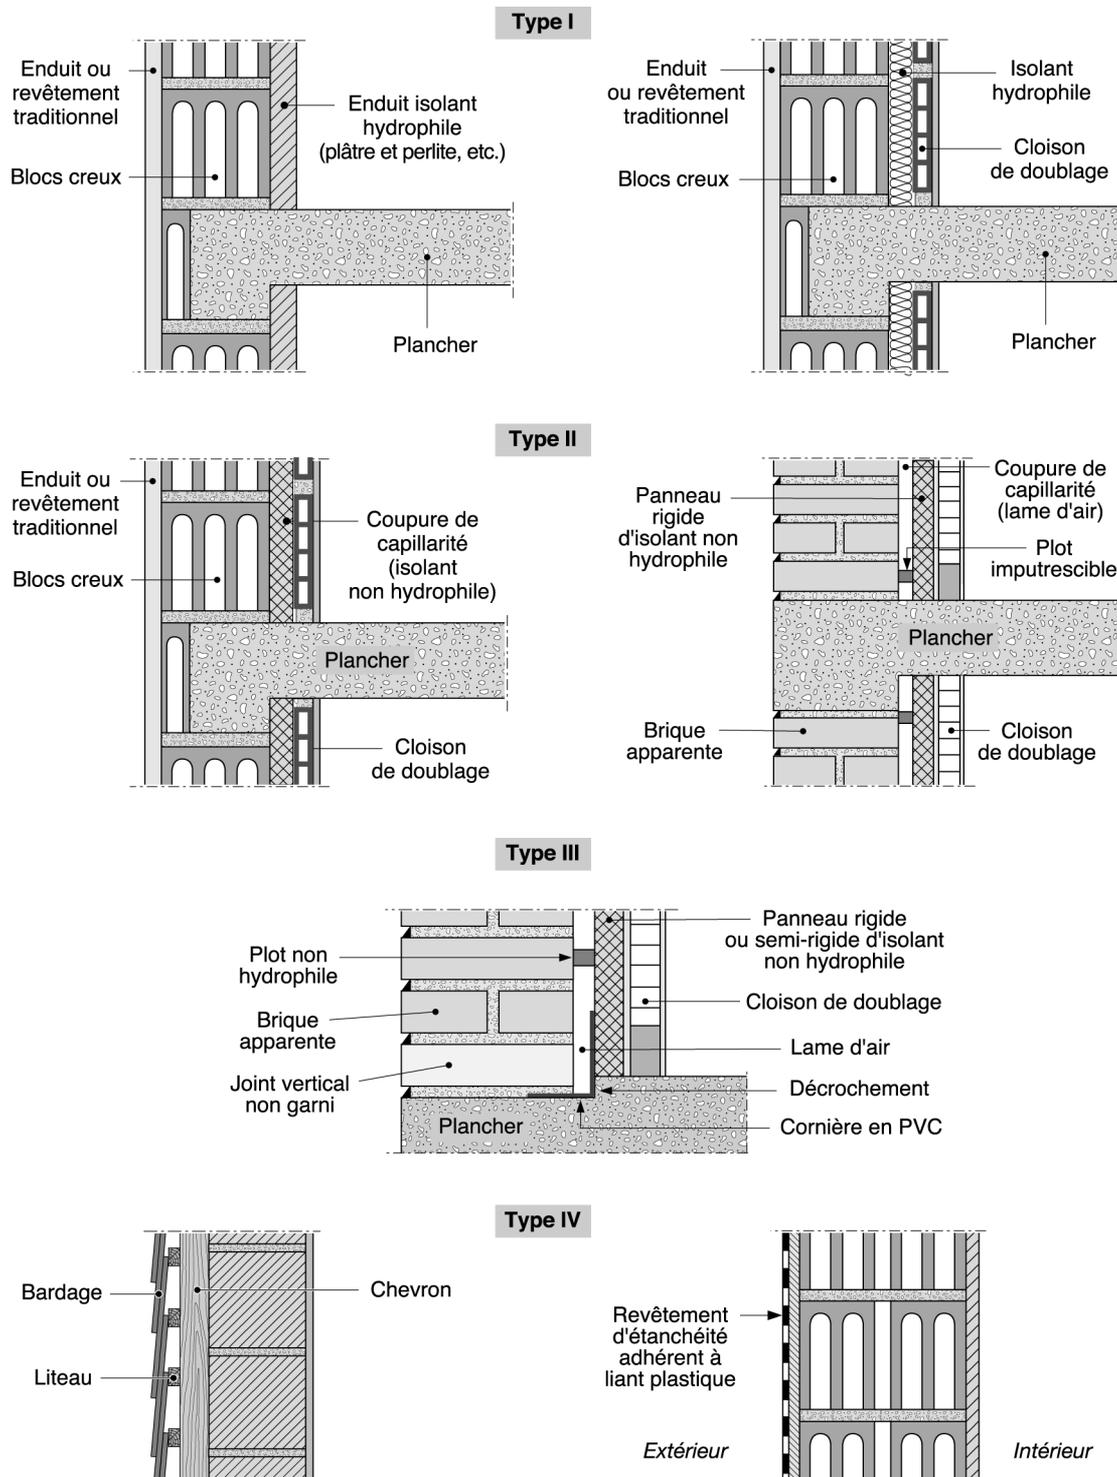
Principaux types de murs de façade en maçonnerie
